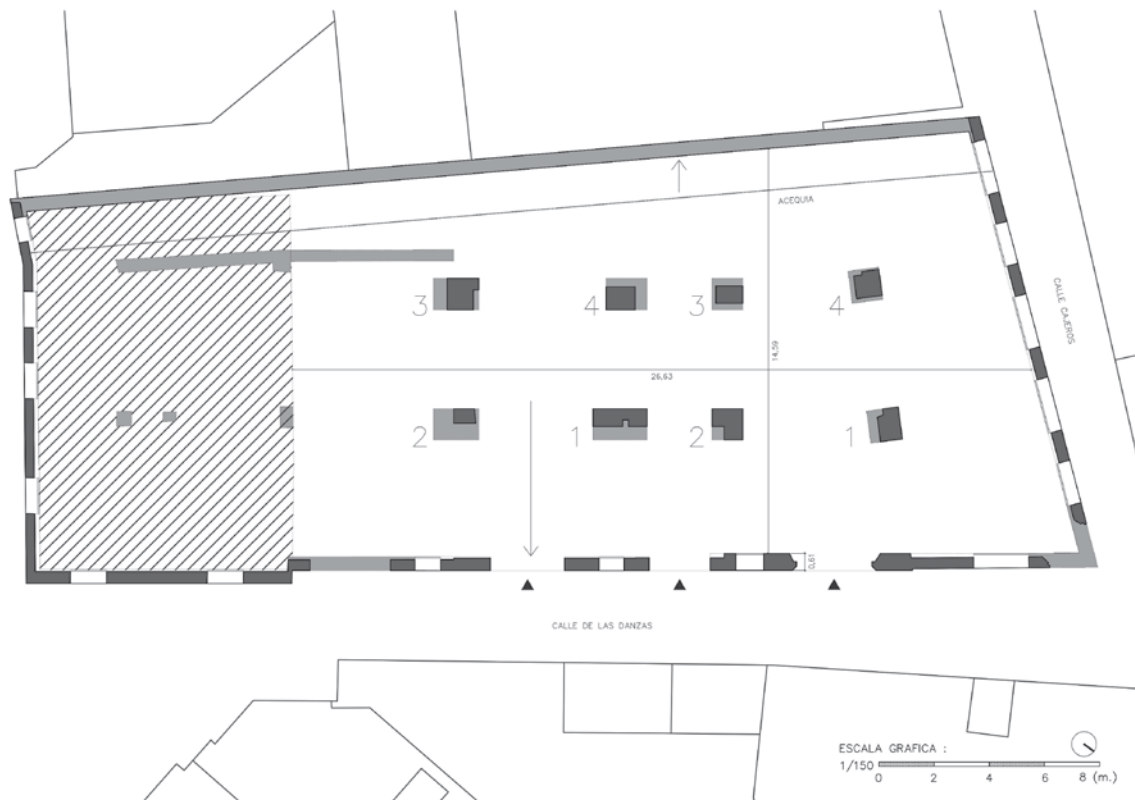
Propuesta de reconstrucción de estructura original en planta.
